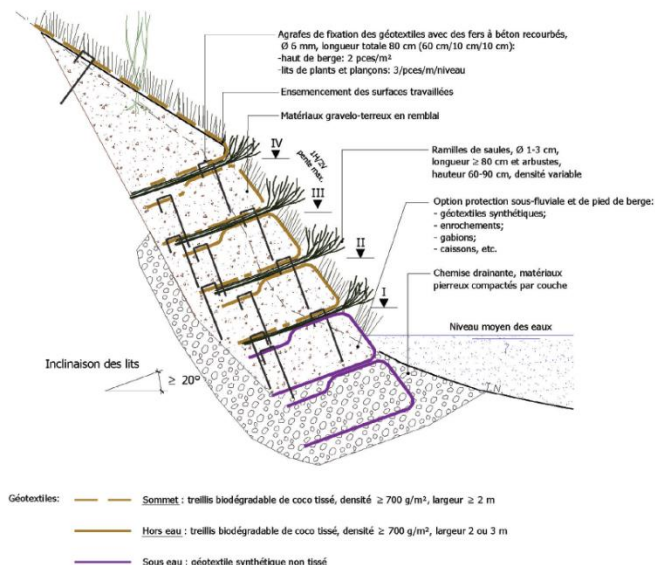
Coupe schématique de plans et plançons renforcés au moyen de « boudins » de géotextiles (Adam et al., 2008)
